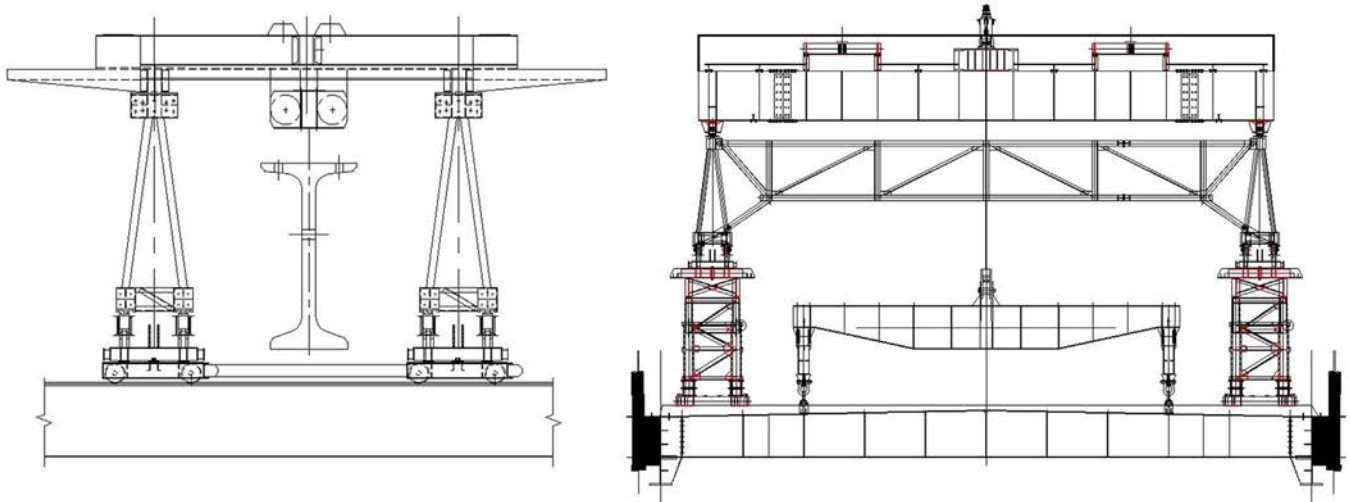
Lanzadoras original y adaptada (con estructuras de arriostramiento entre celosías y puente grúa superior).
